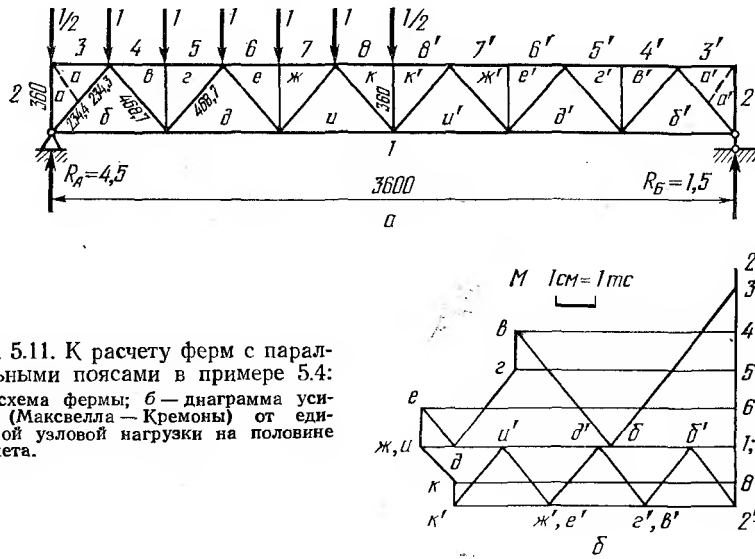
К расчету ферм с параллельными поясами в примере 5.4: а — схема фермы; б — диаграмма усилий (Максвелла—Кремоны) от единичной узловой нагрузки на половине пролета.
